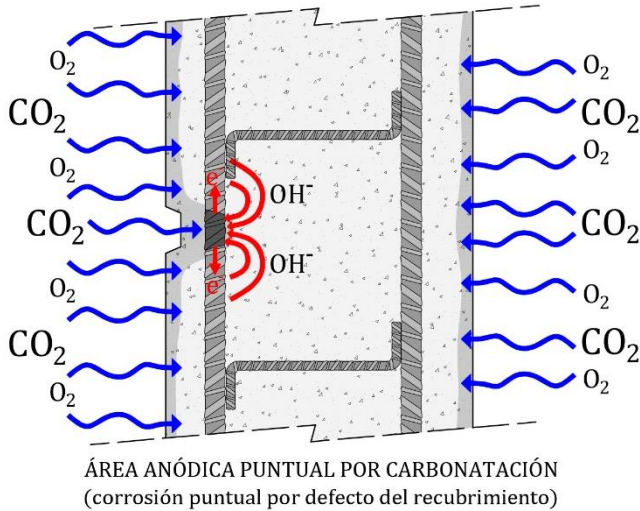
19- Muro de hormigón armado con defecto en el recubrimiento expuesto a carbonatación. Elaboración propia.
